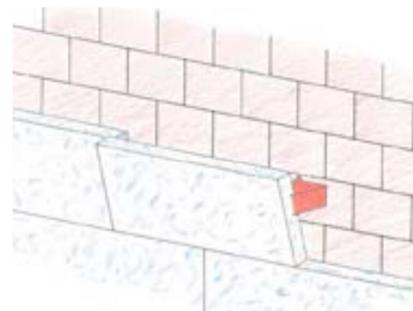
Detalle de la instalación de las planchas de aislamiento en la fachada de un edificio.
